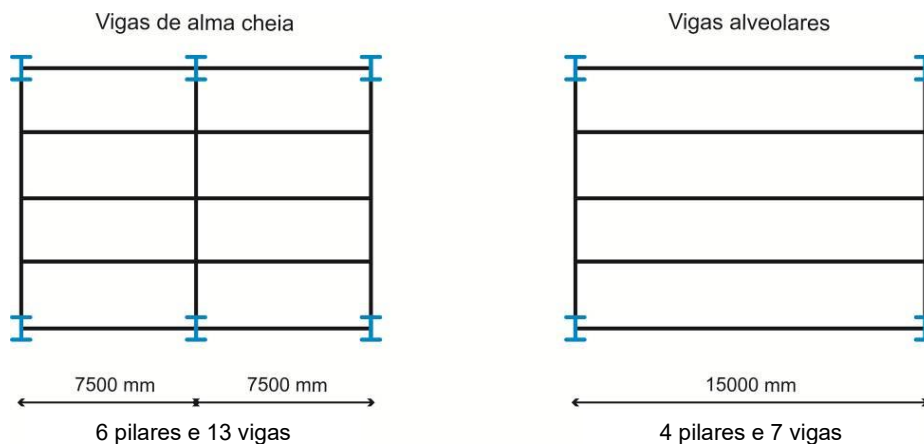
Comparação entre pavimentos com viga de alma cheia e com viga celular.
